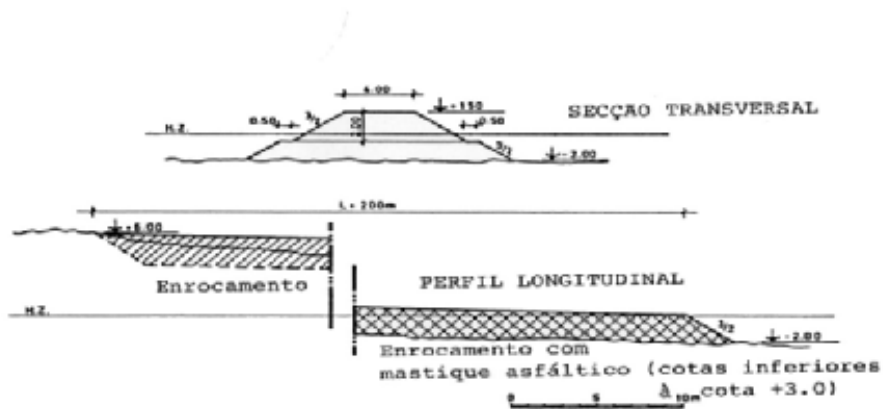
Perfil transversal e longitudinal de uma solução em enrocamento suportado por mástique asfáltico (Veloso Gomes, 2008).
